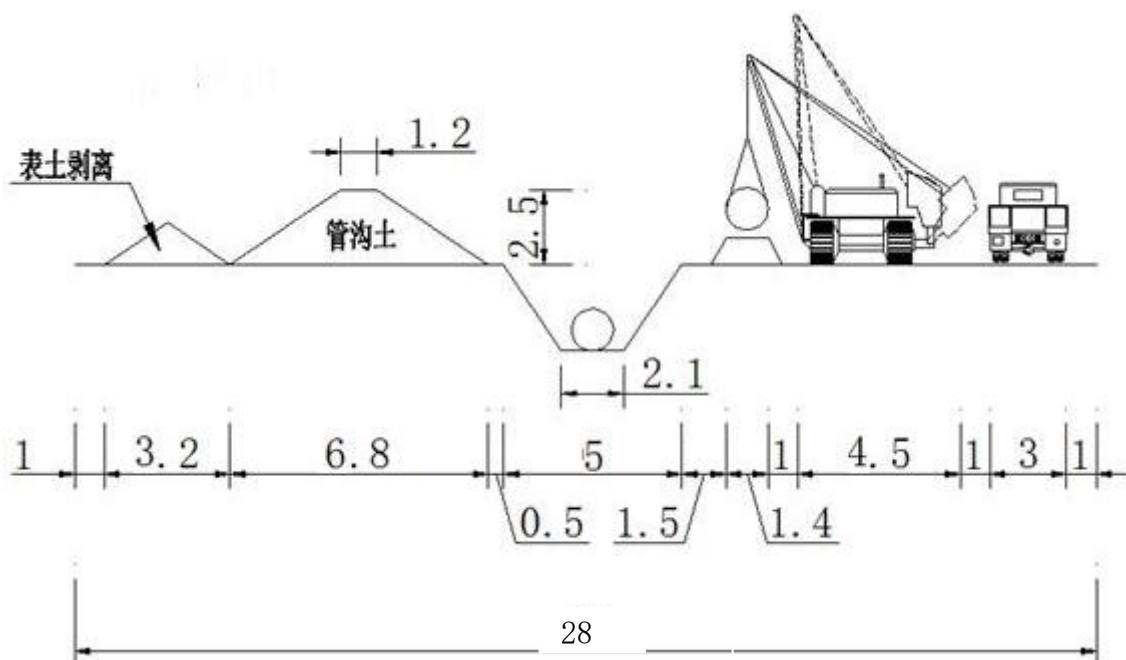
一般地段单管敷设作业带布置(单位: m)
